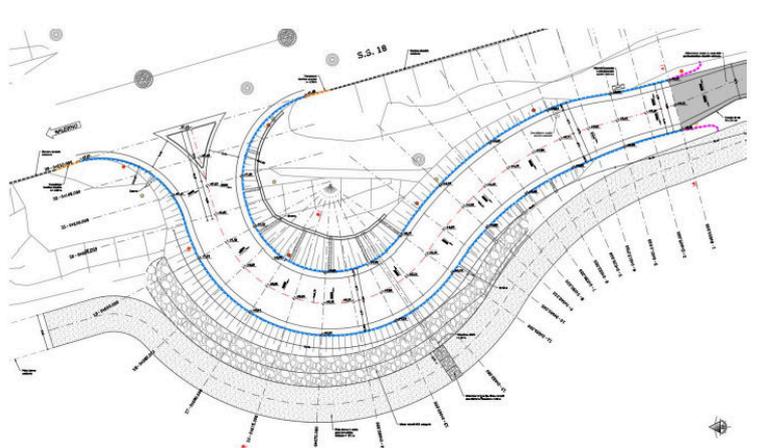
Intervento D - Planimetria raccordo di collegamento porto - SS18
